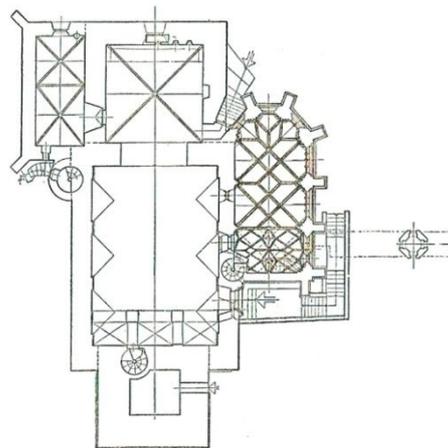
Spišský Štvrtok, Ladislauskirche Zápoľskýkapelle, Grundriss, 13. Jh. und 1473/79
